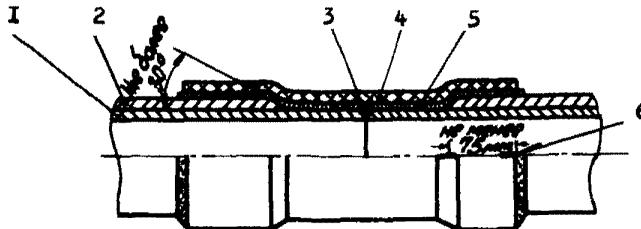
Конструкция изоляционного покрытия зоны сварного стыка из термоусадочной муфты:
